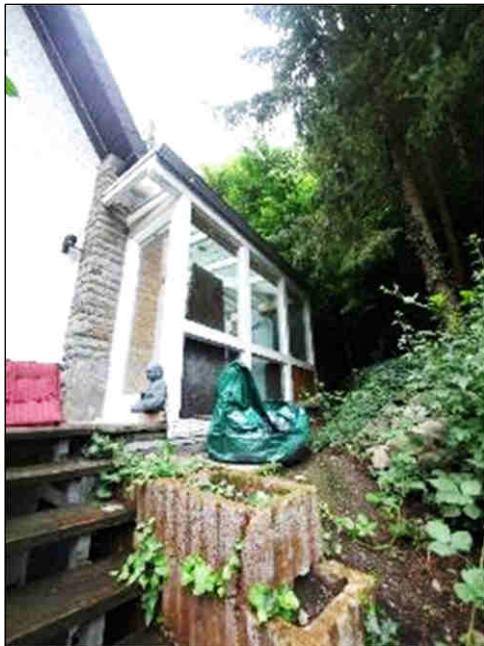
nicht genehmigte Anbauten an der Gebäuderückseite
